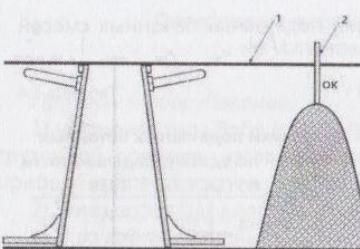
Определение осадки конуса бетонной смеси:
